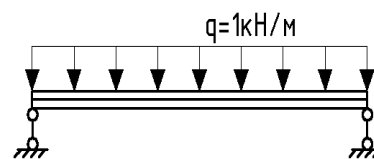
Условия закрепления пластины: шарнирно опертая пластина
